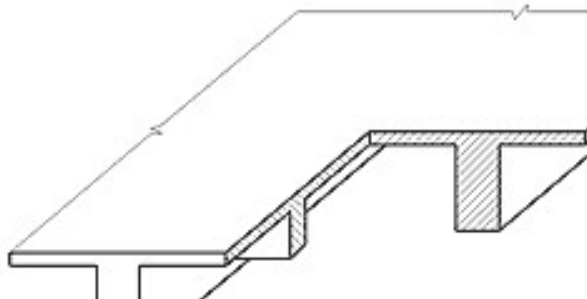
Фрагмент монолітного ребристого перекриття з балковими плитами
